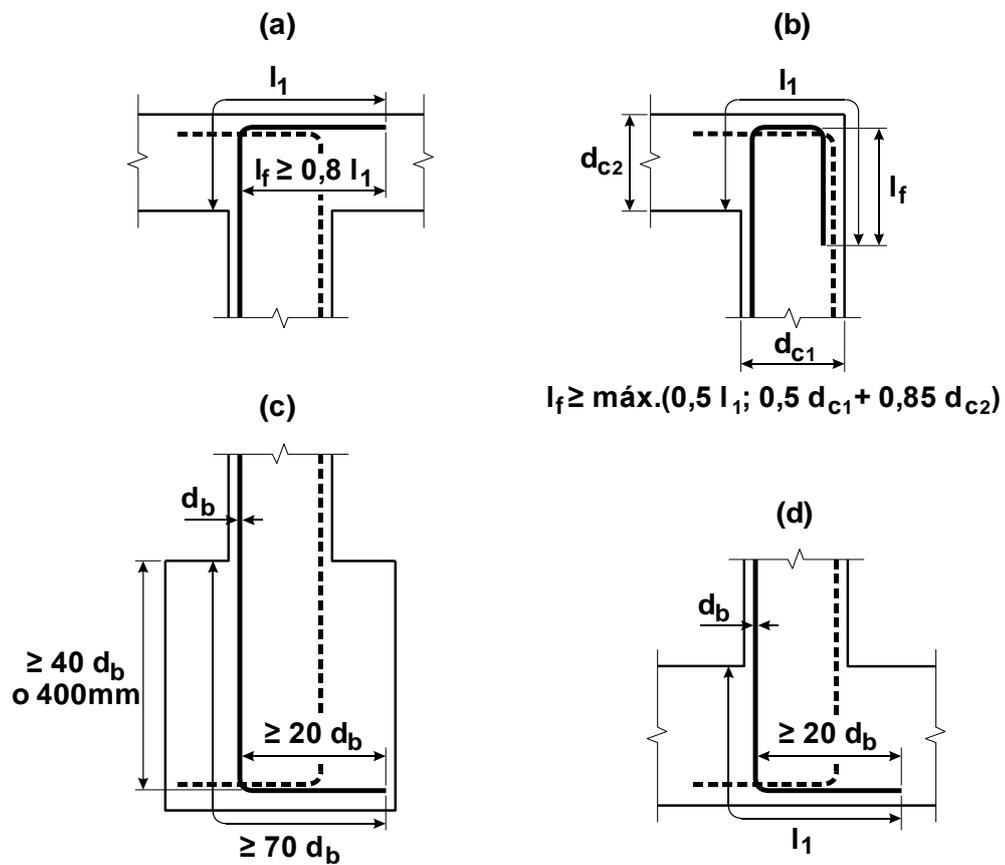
Anclaje de la armadura longitudinal de encadenados de hormigón armado.
